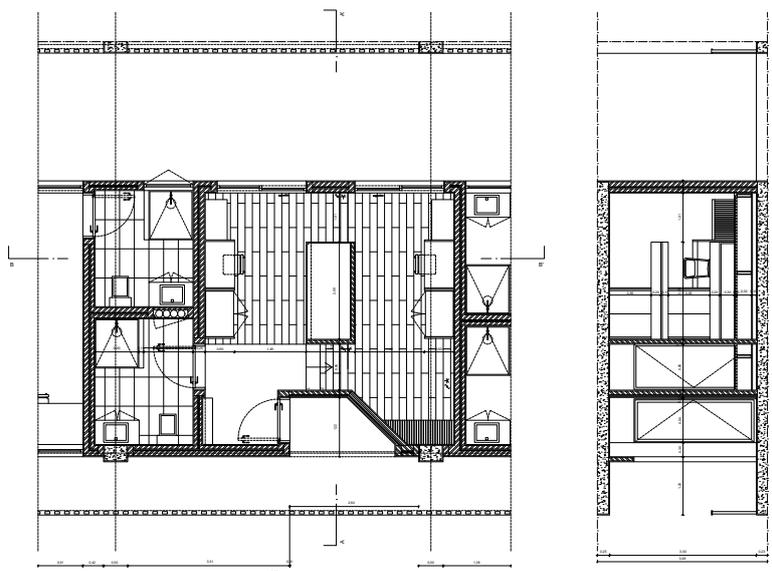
Planta e Corte Transversal do Quarto B | Bloco B
